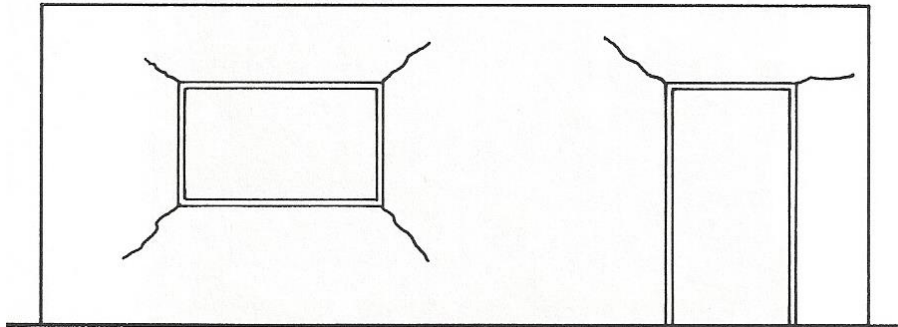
Fissuração típica nos cantos das aberturas sob atuação de sobrecargas.
